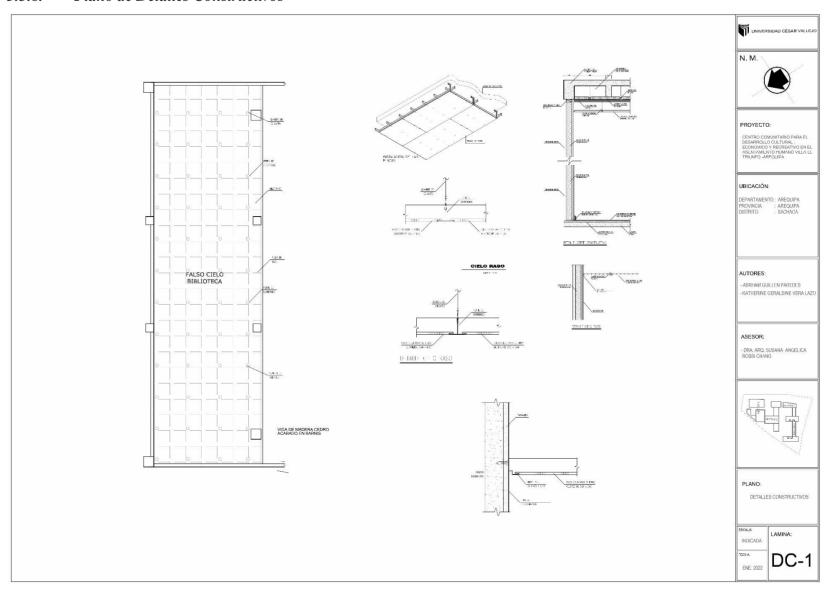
Plano de Detalles Constructivos (Falso cielo raso) - Elaboración propia
